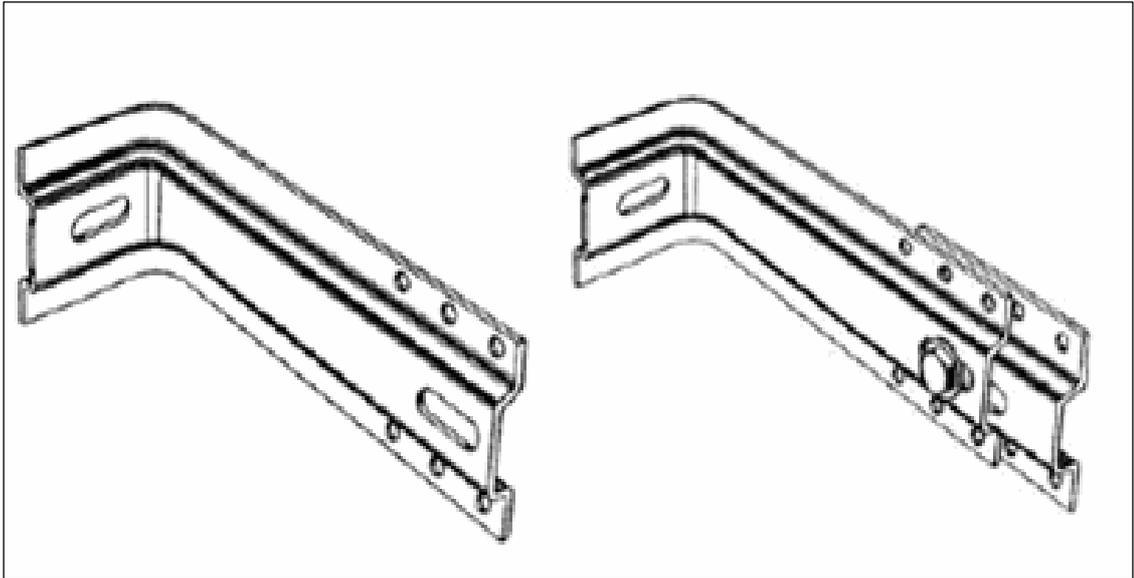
Escuadra utilizada en la fijación de la estructura al muro.
